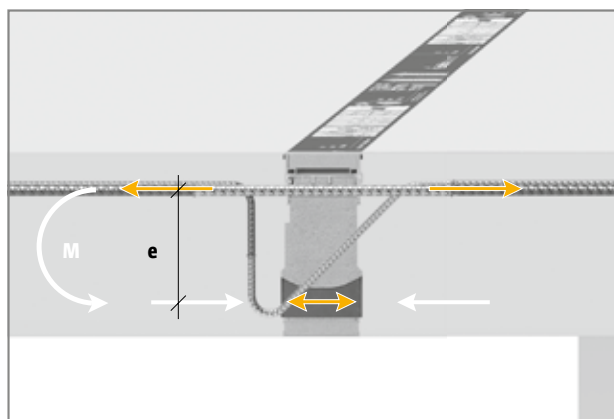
Schöck Isokorb® T tipo KL: trasmissione del momento
